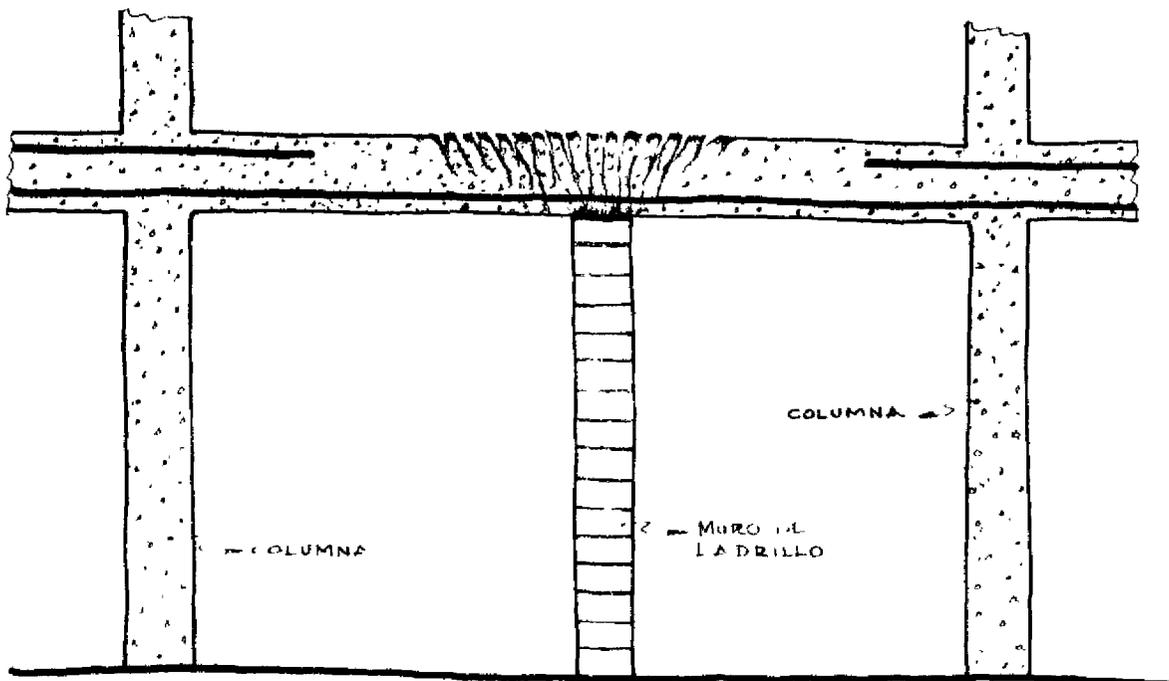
Efecto de apoyo sobre un muro de ladrillo.
